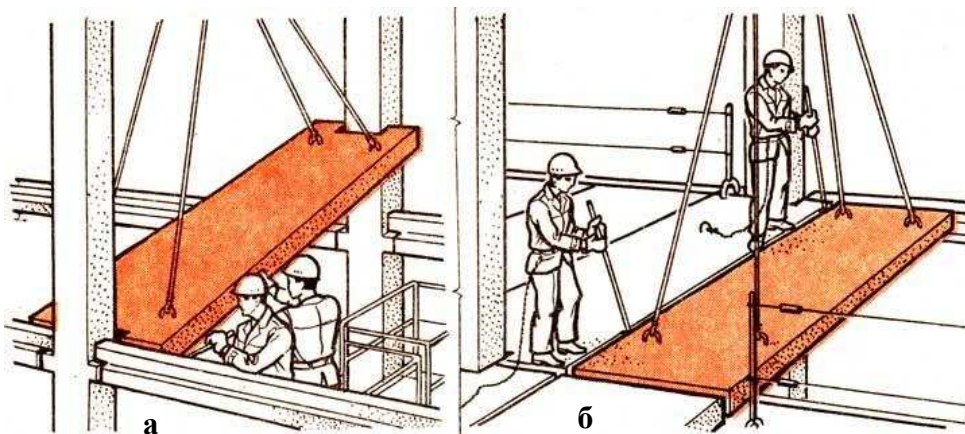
Схема укладання плит покриття: а – розпірної; б – рядової
